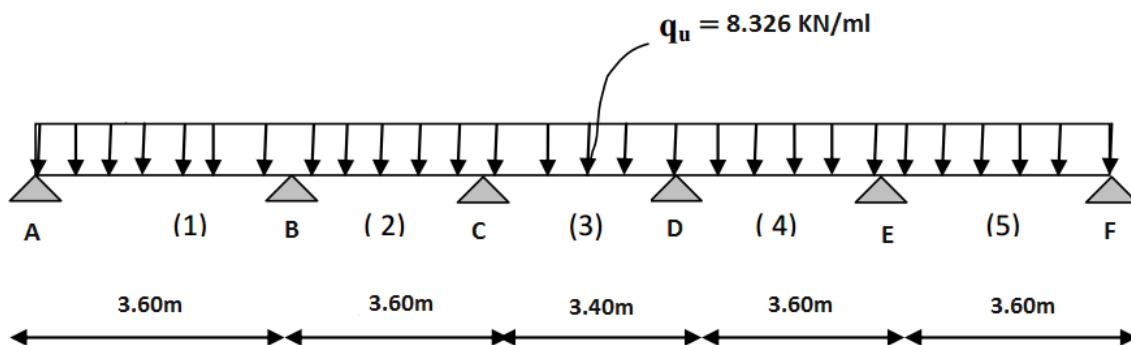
Schéma statique de la poutre continue reposant sur six appuis.
